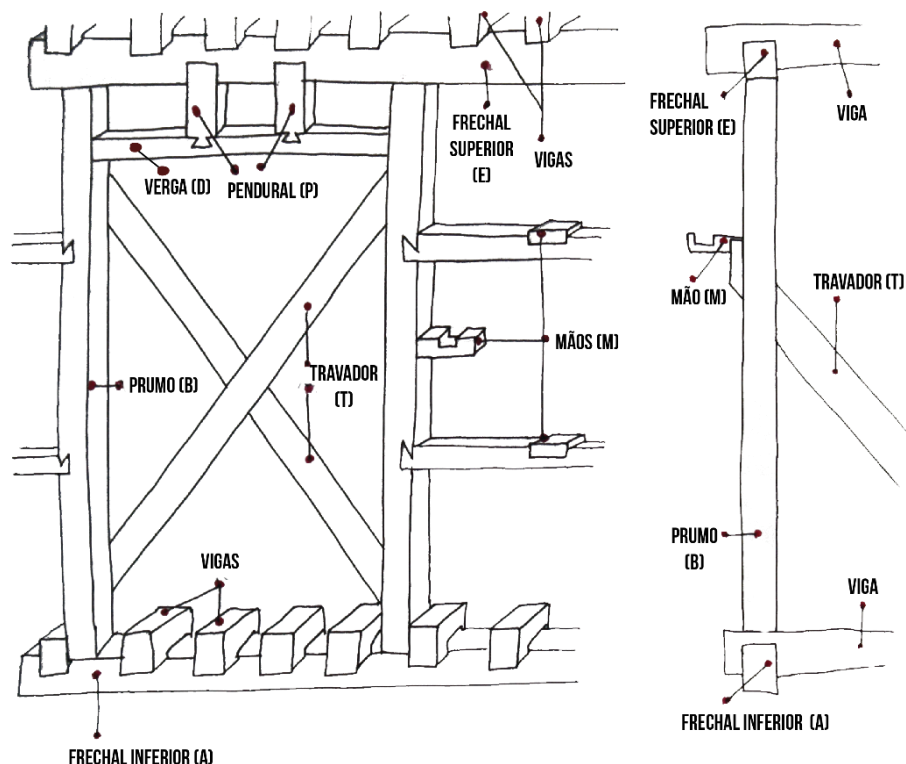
Gaiola de madeira inserida em parede de alvenaria exterior
